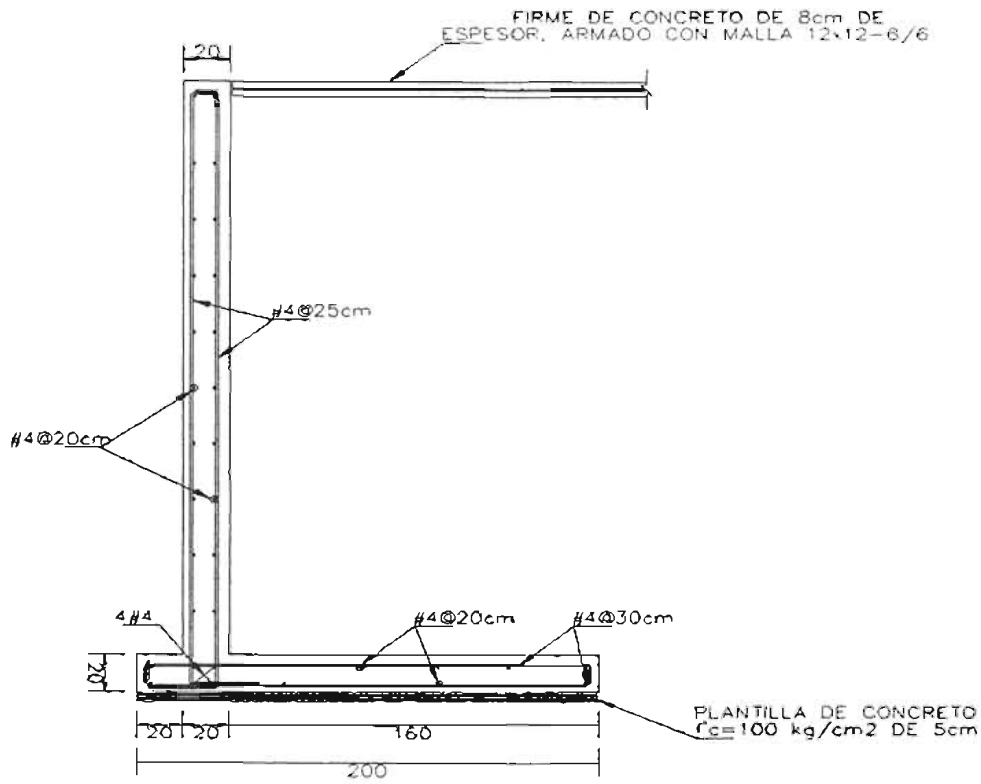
Muro Perimetral del cajón de cimentación. (Tipo)
